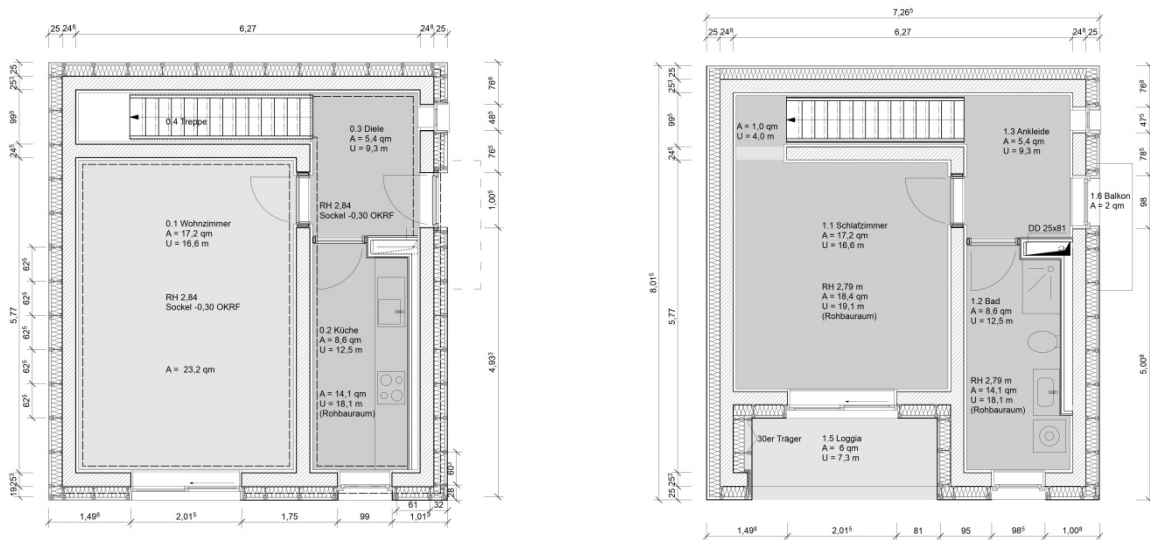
Variante 4: Fassadensystem aus Stegträgern, Mineralwolle und Eternit- Grundriss im EG (links) und OG (rechts)
